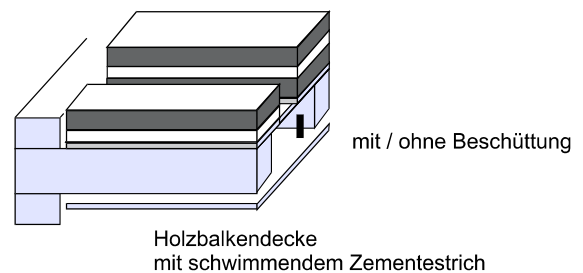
Schema Holzbalkendecke mit Unterdecke und Fußbodenaufbau
